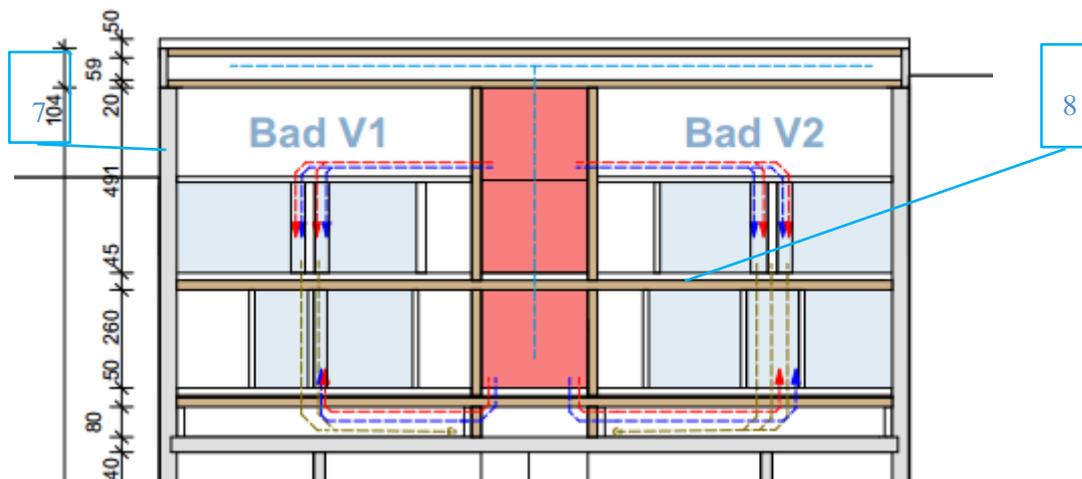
Längsschnitt – Übersicht Bauteilaufbauten [Anschluss an die benachbarten Gebäude]
